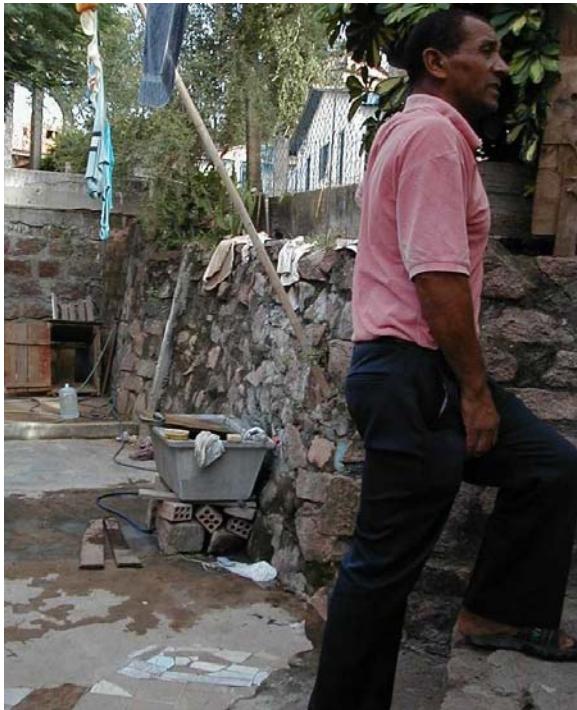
Detalhe do muro existente em frente casa 347 (LD). Altura 2,00m.
